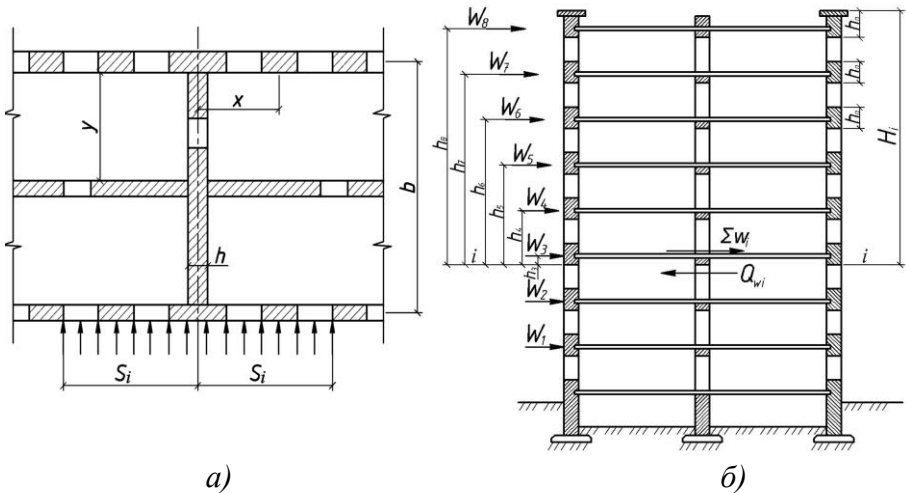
Схема будівлі при розрахунку на вітрове навантаження: a – план; b - розріз
